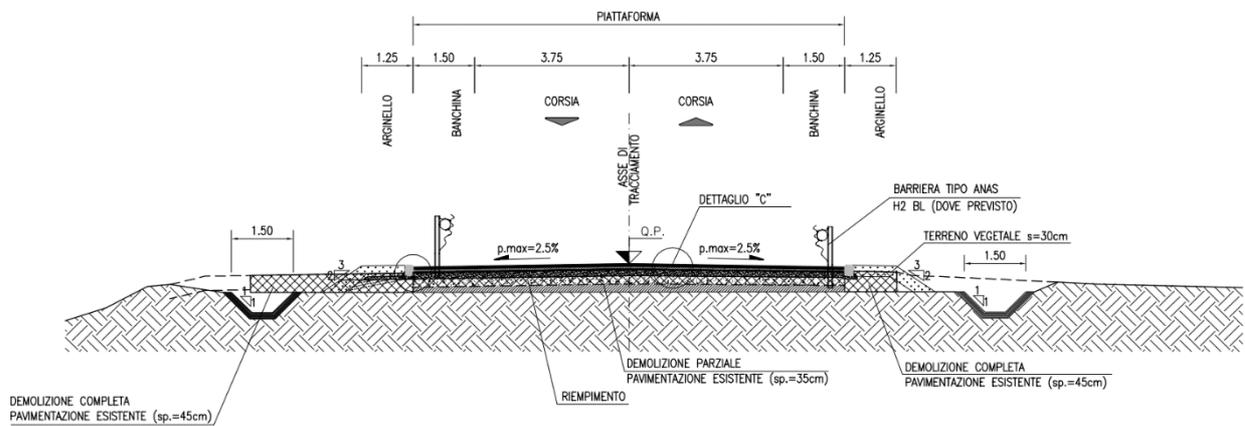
Sezione tipo: Ramo 3 (Strada comunale di accesso)
